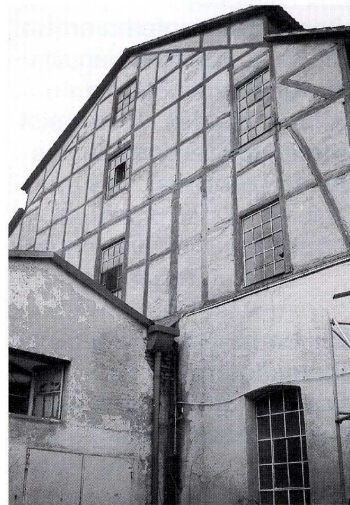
Nördliches ehemaliges Mühlengebäude mit Fachwerkaufstockung, Nordfassade
